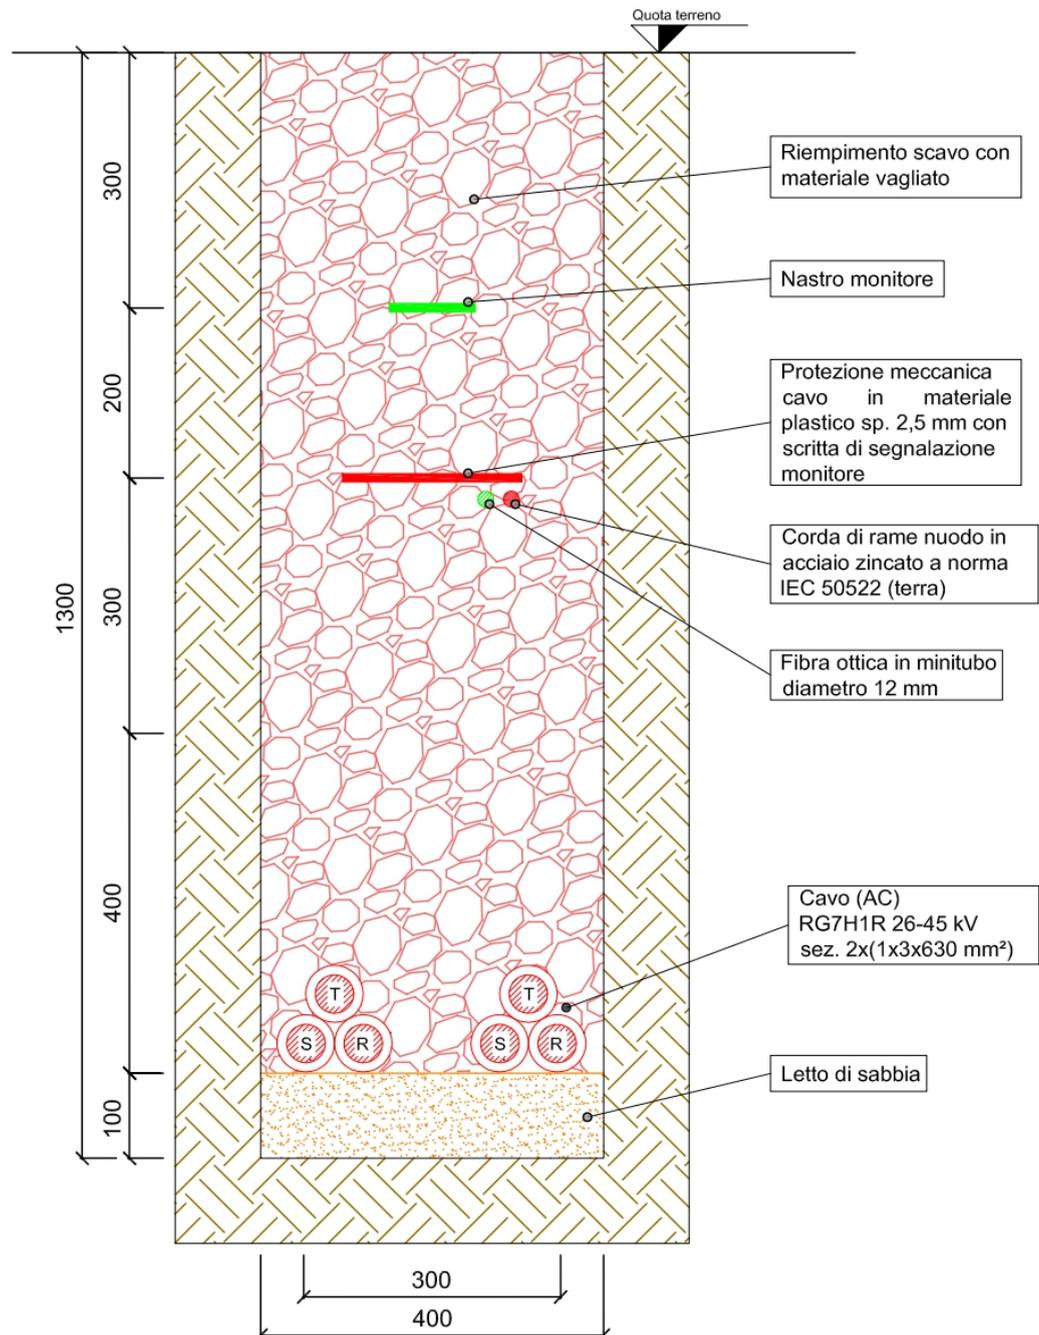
Tipico sezione di posa con due cavidotti interni da 3x630 mm²
